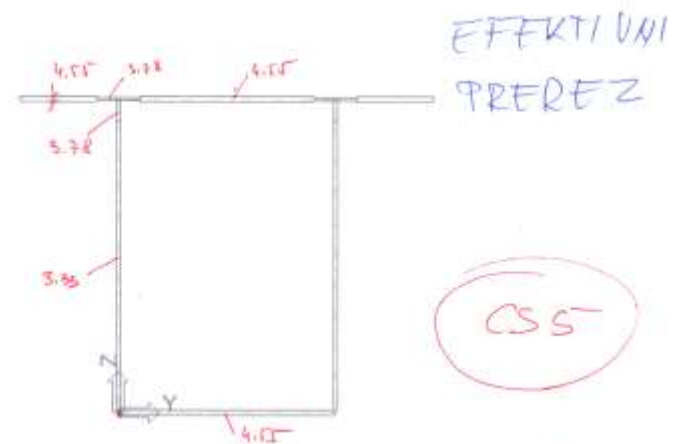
Wirksame Dicken in einem Querschnitt der Klasse 4 mit Schweißnähten
